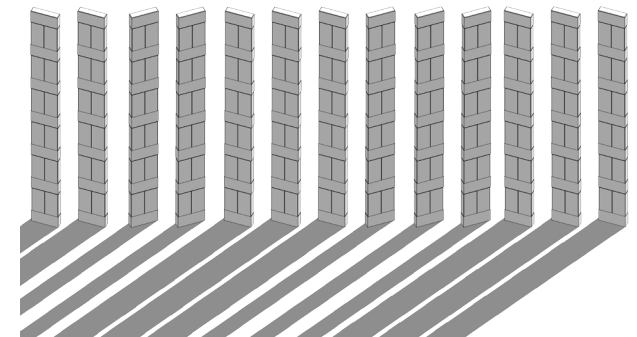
Arranjo de tijolos dos Brises e esquema de disposição dos elementos. Fonte: Produção própria.
